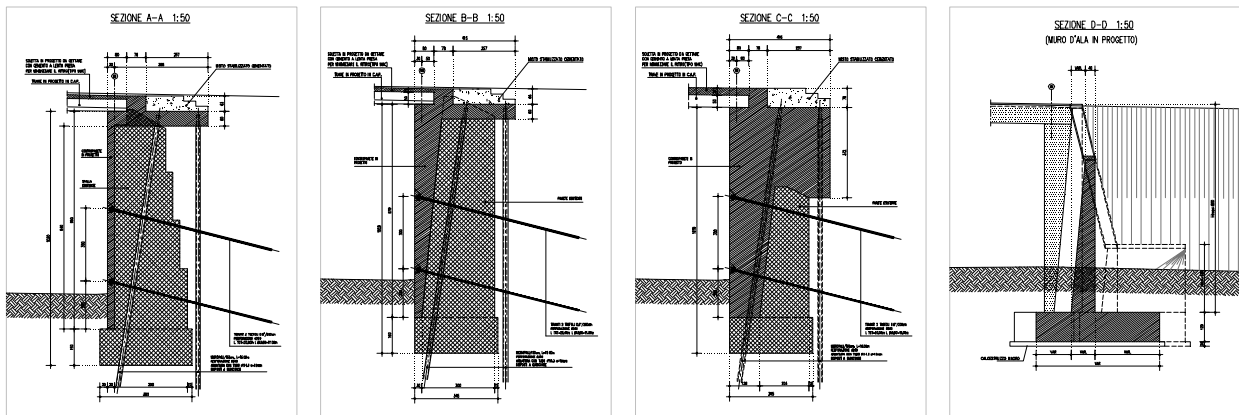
Spalle – Sezione trasversale spalla e muro d'ala
